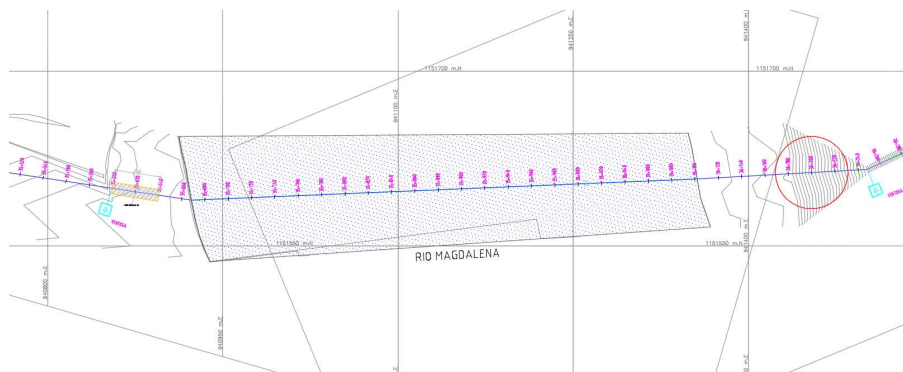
Planta del cruce subfluvial proyecto acueducto alternativo puerto Boyacá
